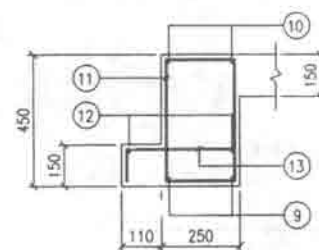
号~7号钢筋混凝土化粪池 现浇盖板配筋图(二)		图 集 号	91SB4-1
